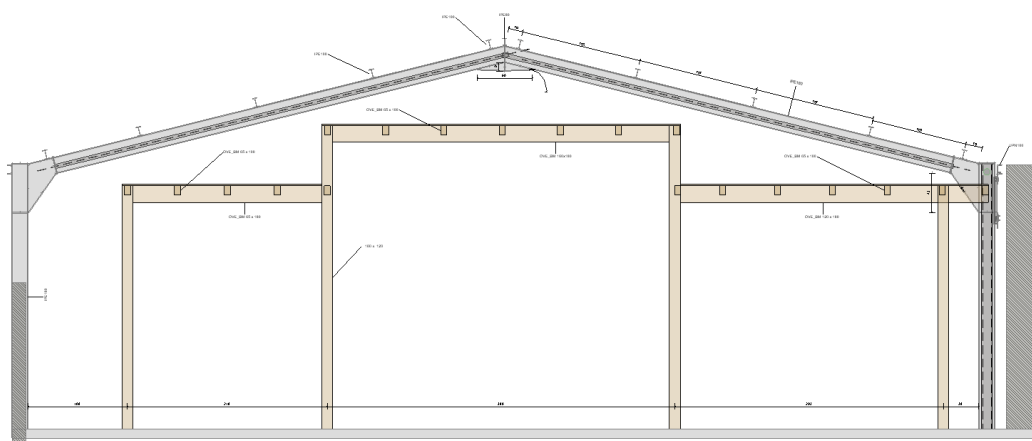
Coupe au niveau de la boîte dans la boîte.
